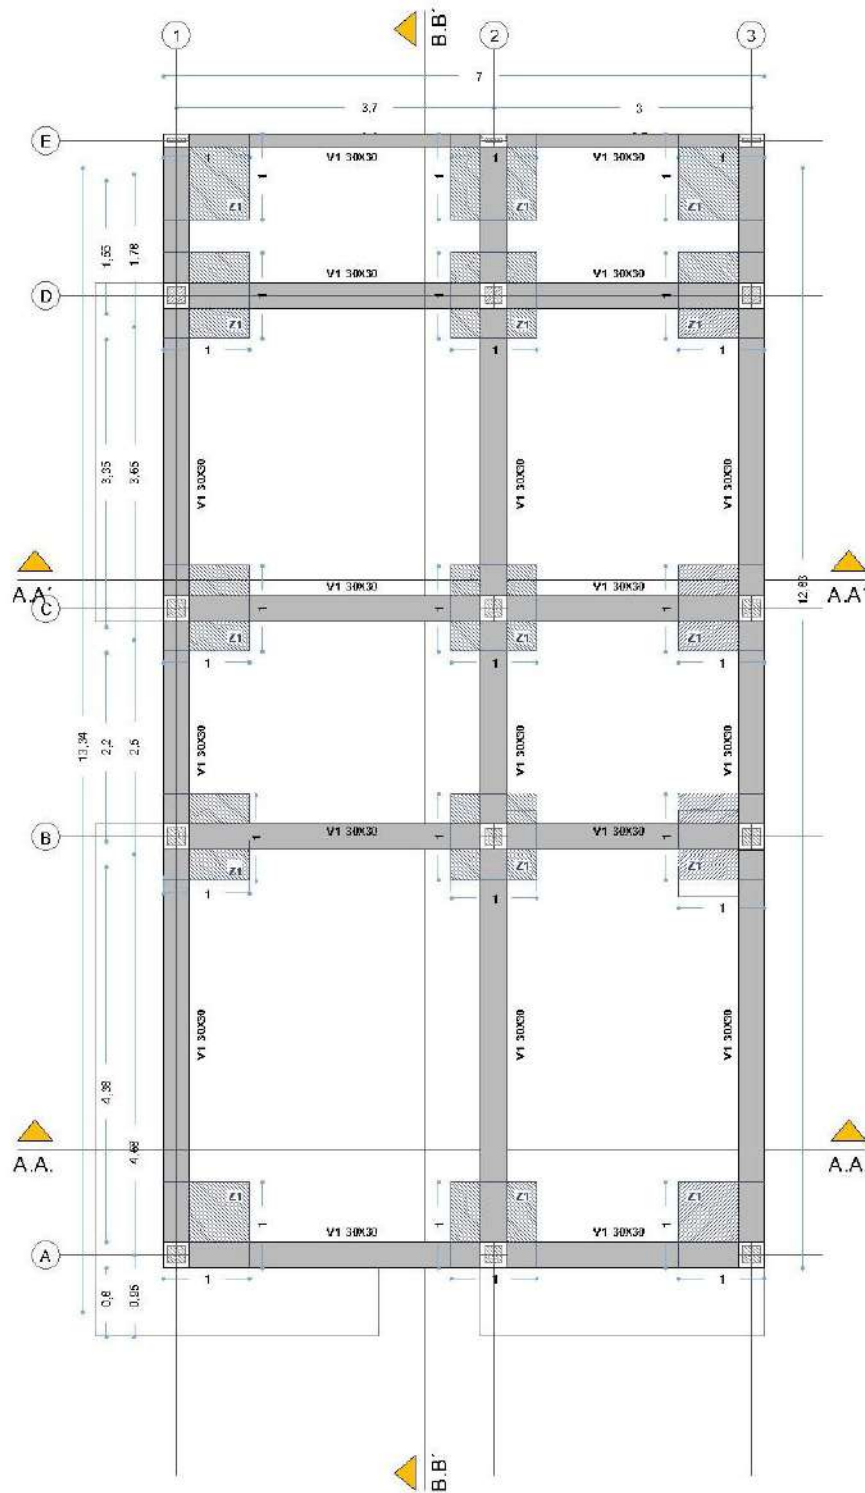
Planta cimentación casa San Sebastián; Fuente: Constructora Pérez
